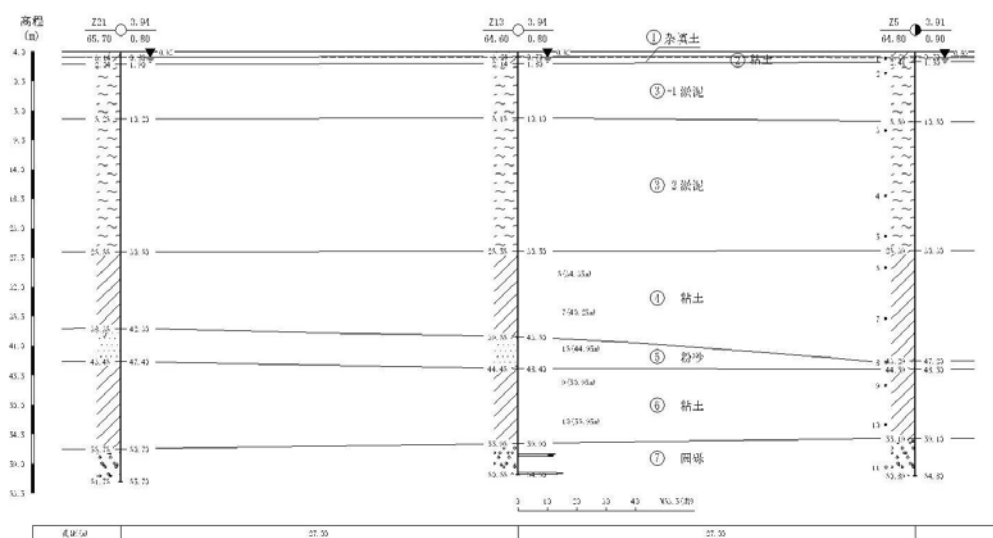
项目所在区域地层岩性 5-5' 典型剖面图
